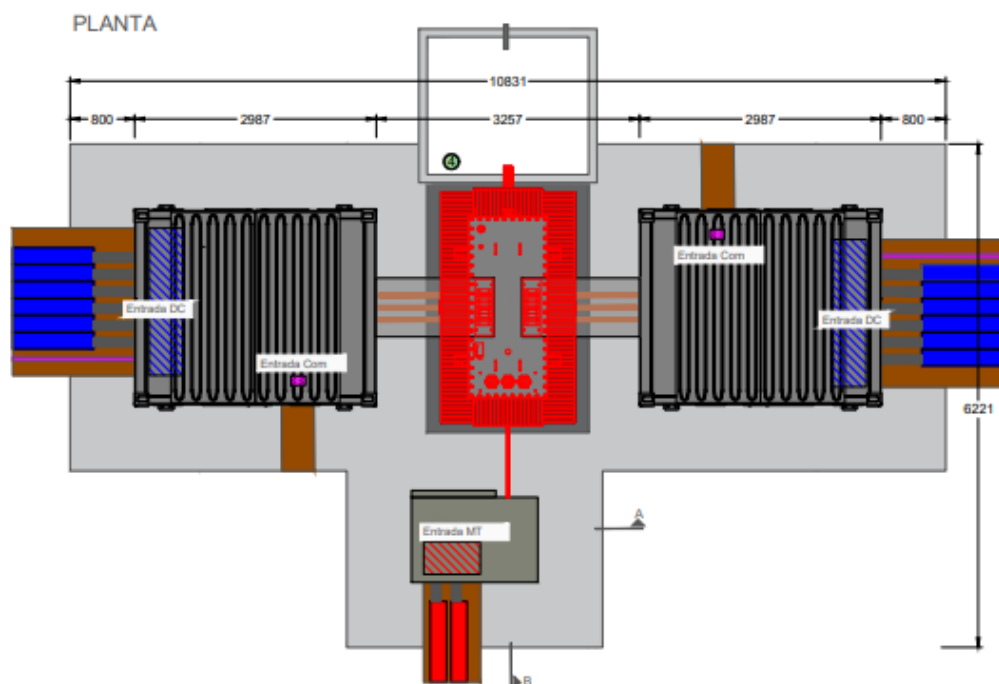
Detalle en planta de centro de transformación tipo. Fuente: Proyectos ejecutivos de las plantas fotovoltaicas.
